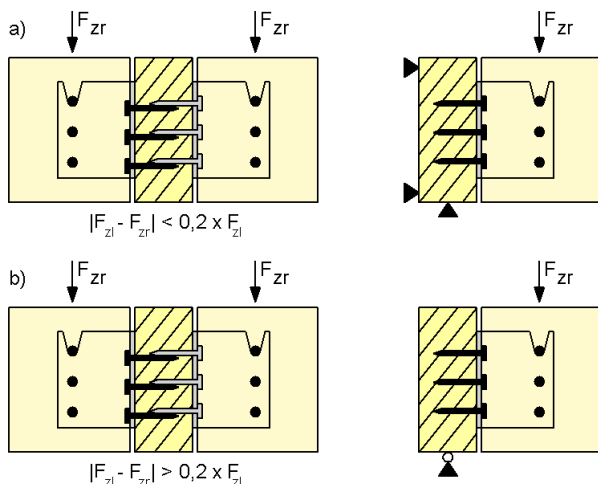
Lagerung bzw. Halterung des Hauptträgers
